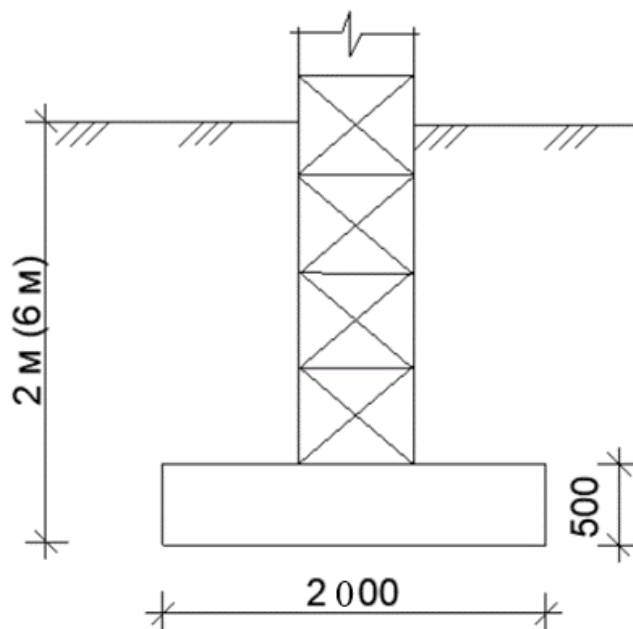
Схема фундаменту, що прийнята для моделювання суцільного ґрунто-пального масиву в межах умовного фундаменту
